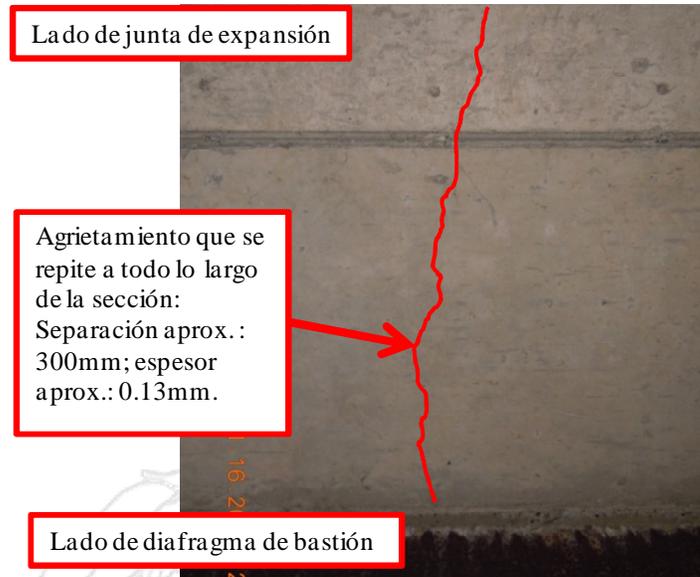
Agrietamiento en la superficie inferior de la sección de losa en voladizo adyacente a la junta de expansión sobre el bastión este.
